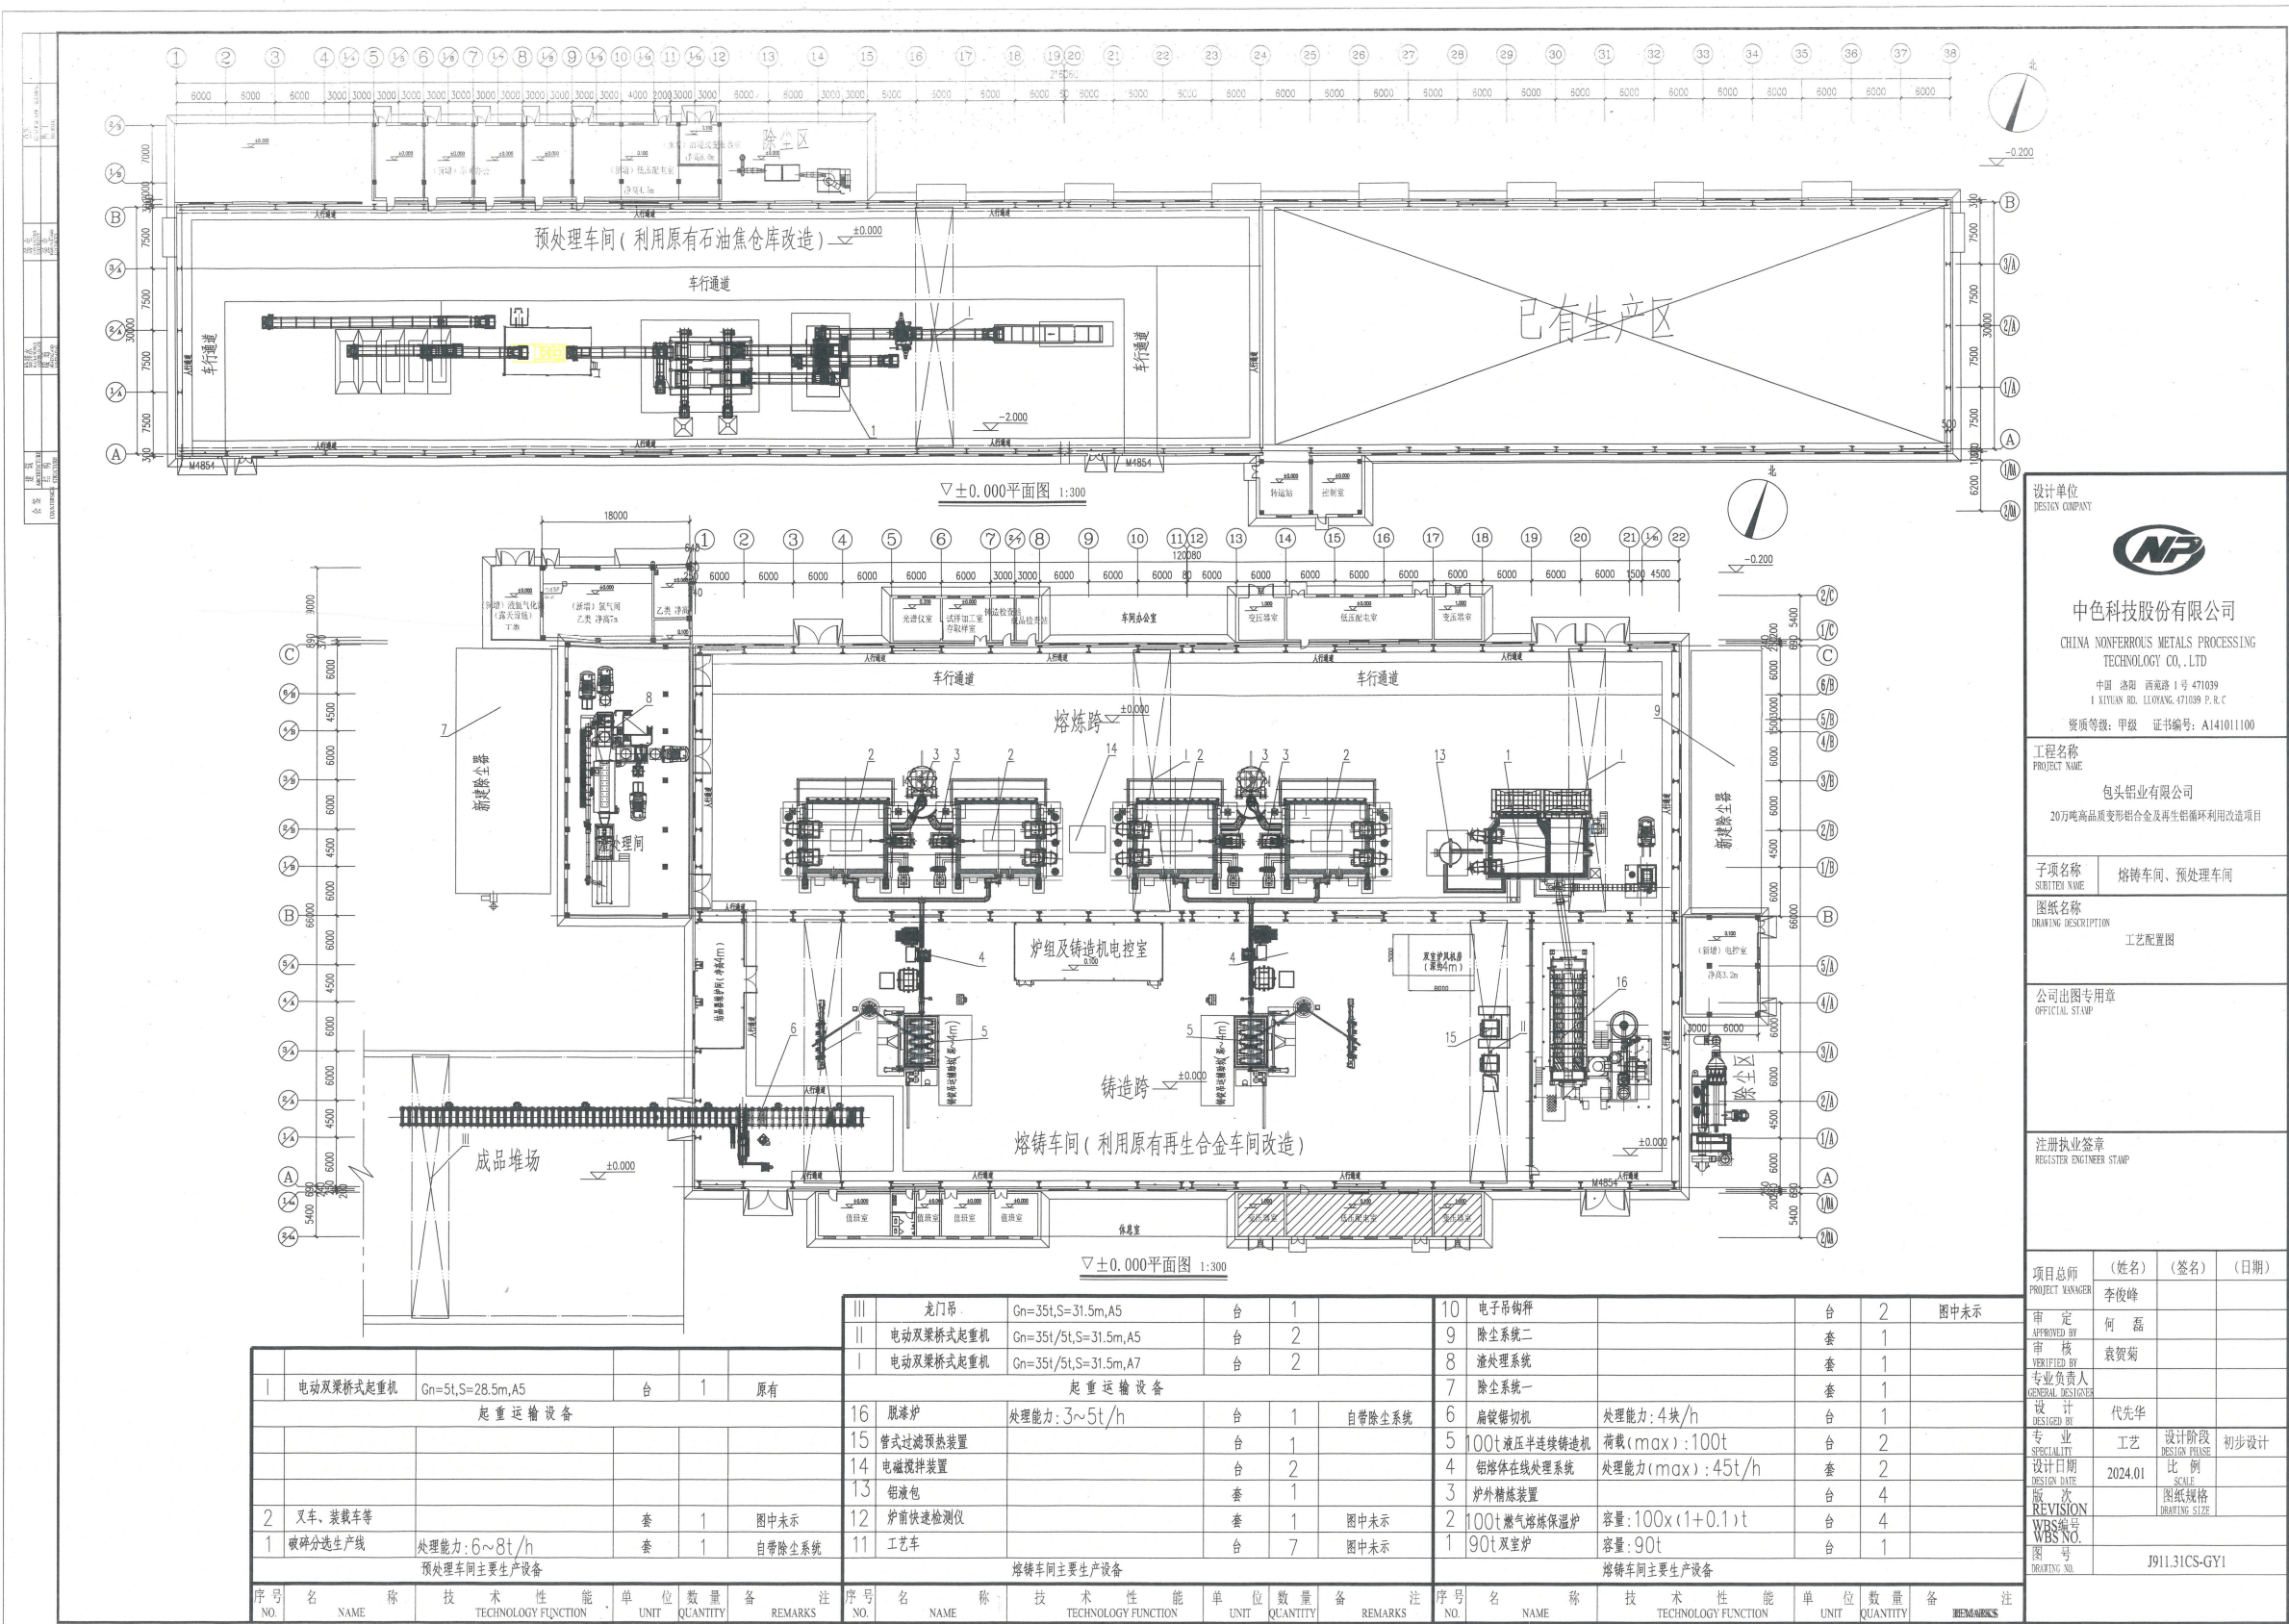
预处理车间、熔铸车间内部平面布置图
